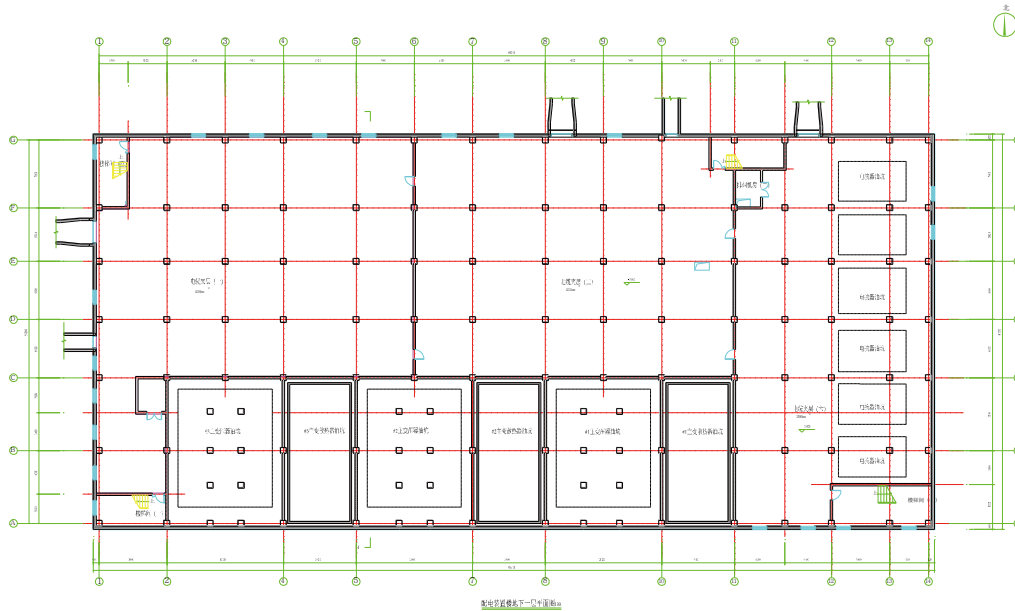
TJ-220-A2-4 方案电缆夹层平面布置图
